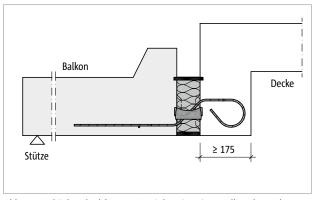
Schöck Isokorb® T Typ QL: Einbausituation "Balkonplatte als Fertigteil"
